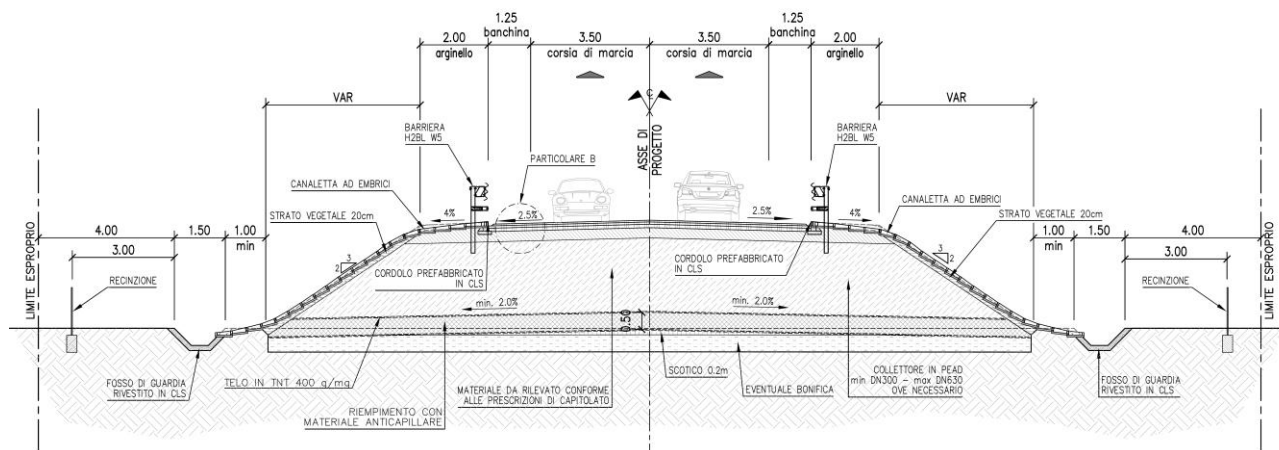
Sezione tipo in rilevato dell’asse secondario - Complanare Casic “Dorsale Consortile”
